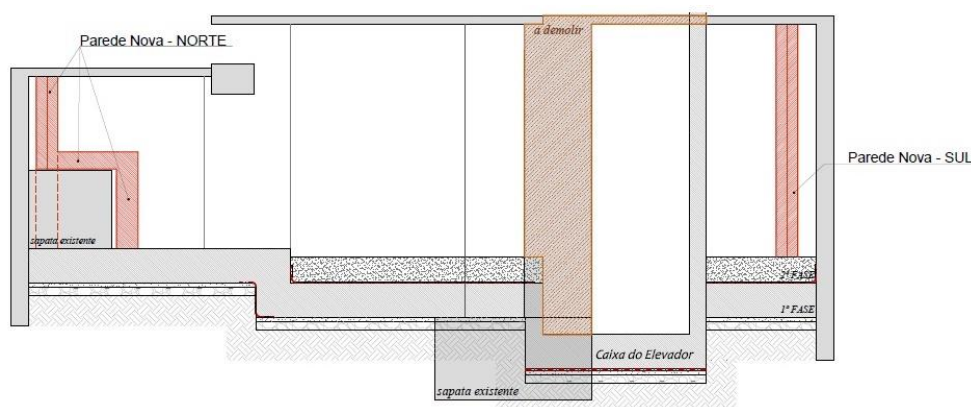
Corte transversal da cave com a indicação das paredes resistentes a norte e a sul
